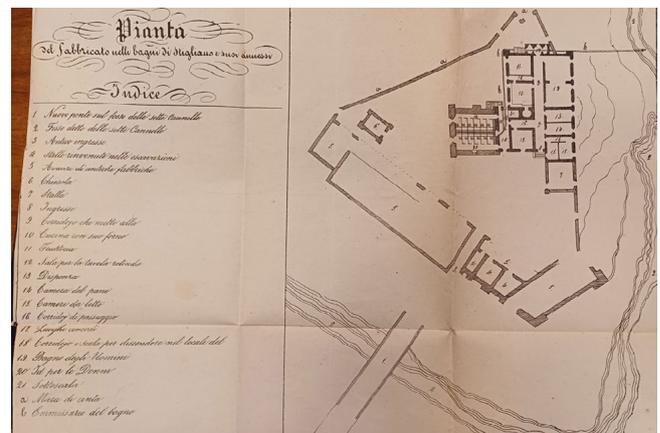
Planimetria della stazione termale nel 1852, dopo la ristrutturazione (Zenitter & Tittoni 1852).
